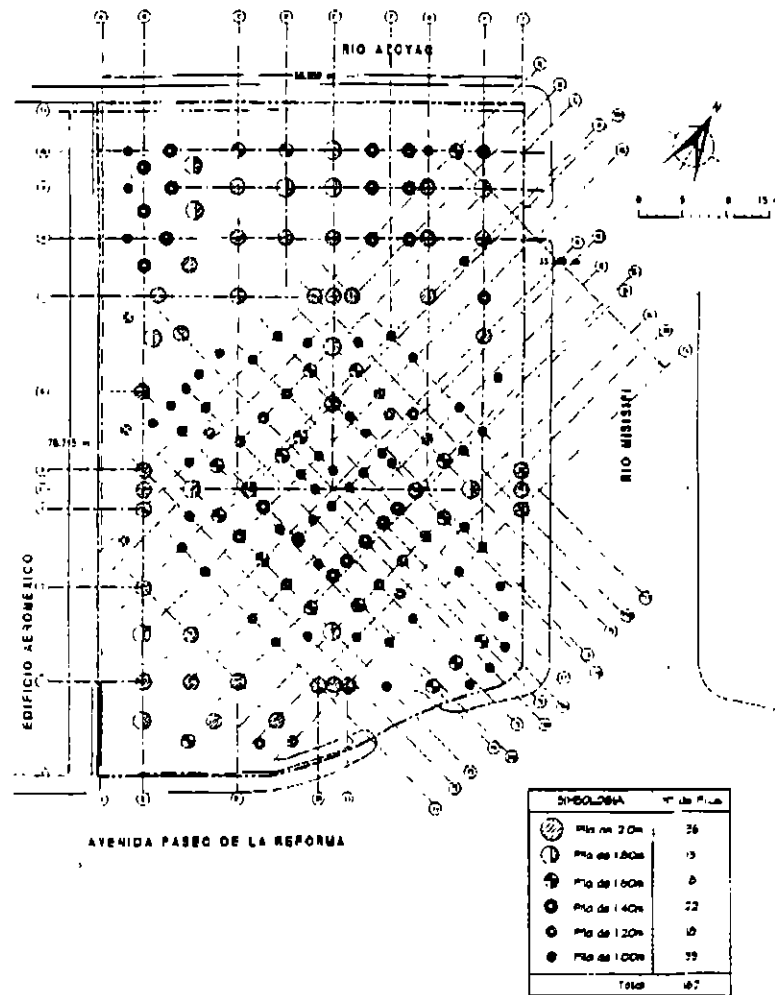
Distribución de pilas (Cortesía de Carlos E. Gutiérrez)
